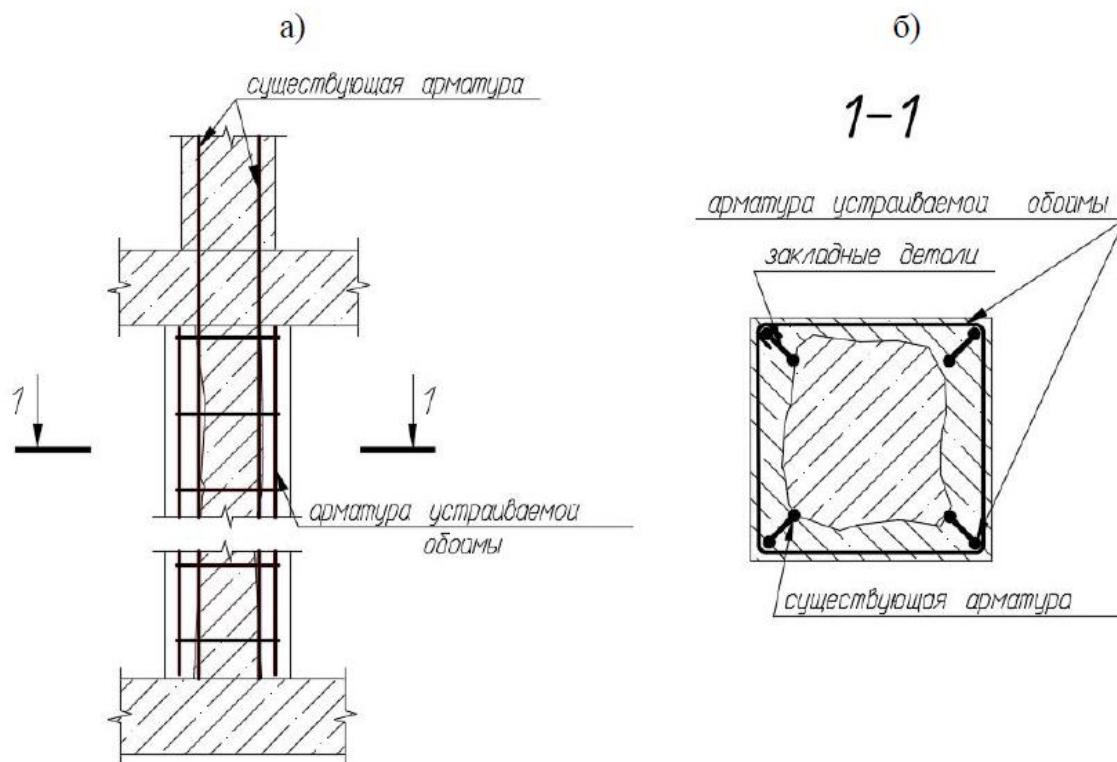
Железобетонная обойма усиливаемой колонны: а) – общий вид; б) вид по сечению 1–1
